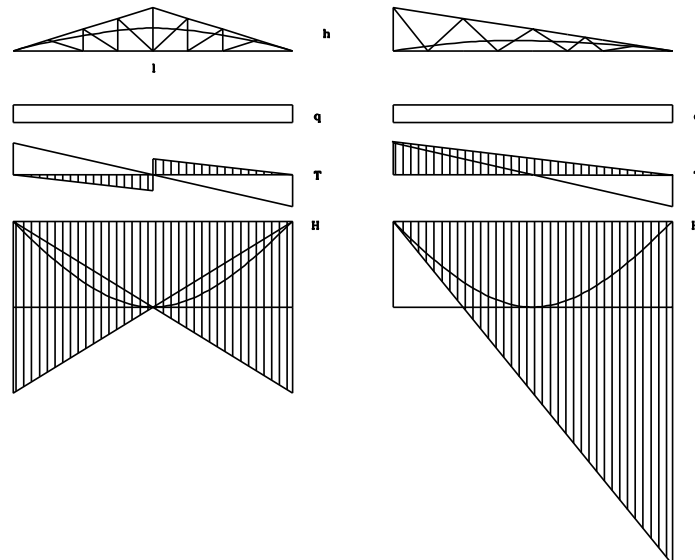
Cantidad de estructura y ángulo de arranque en apoyo
